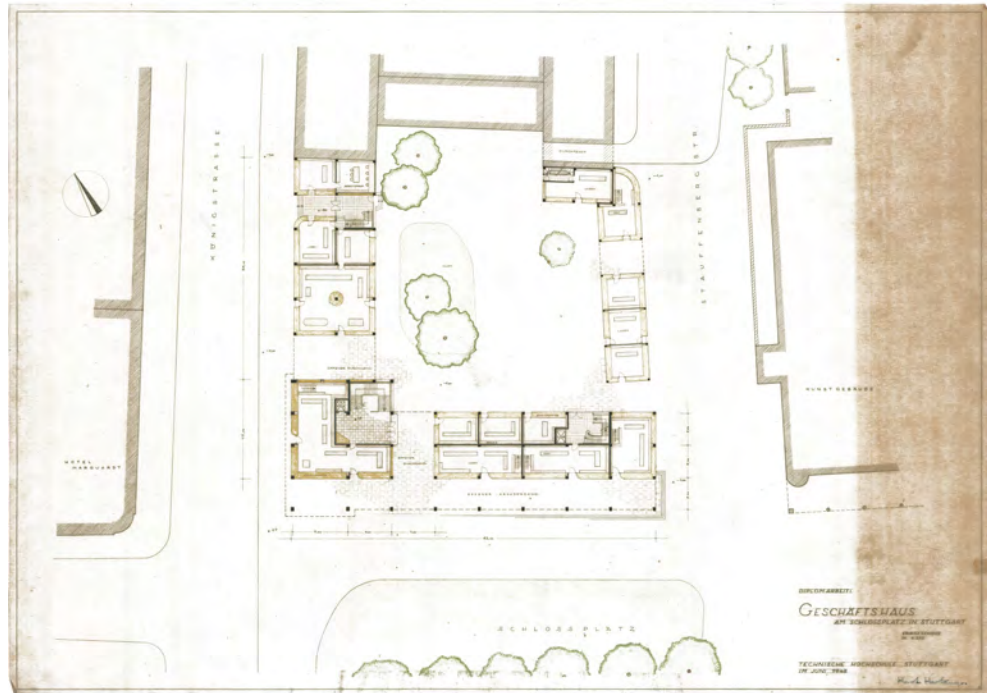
Diplomarbeit „Olgabau“, Grundriss EG
